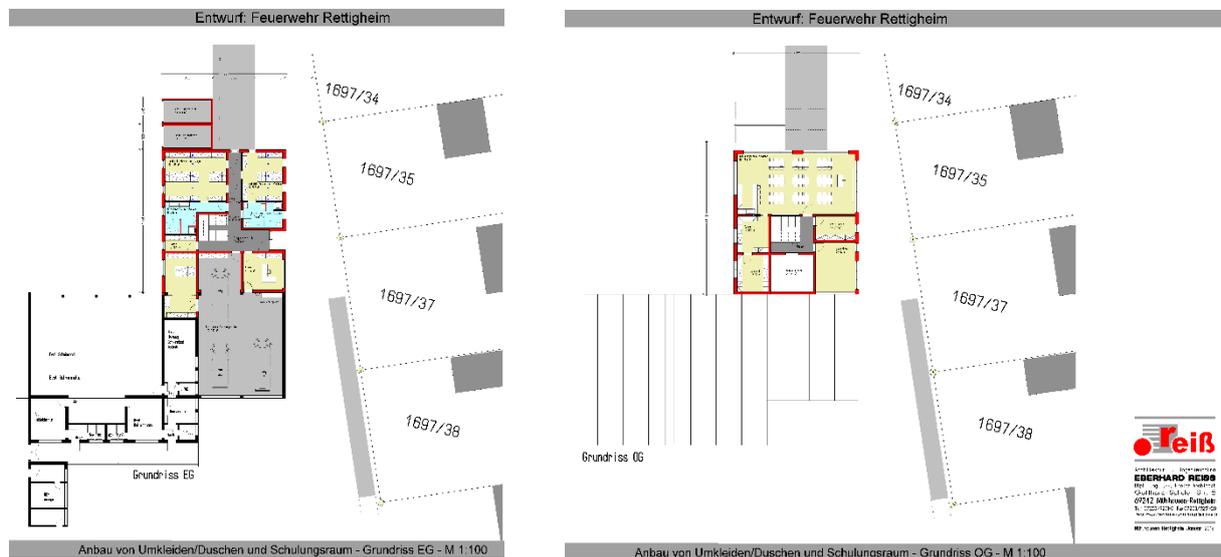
Grundrisse des neuen Feuerwehrgerätehauses.
